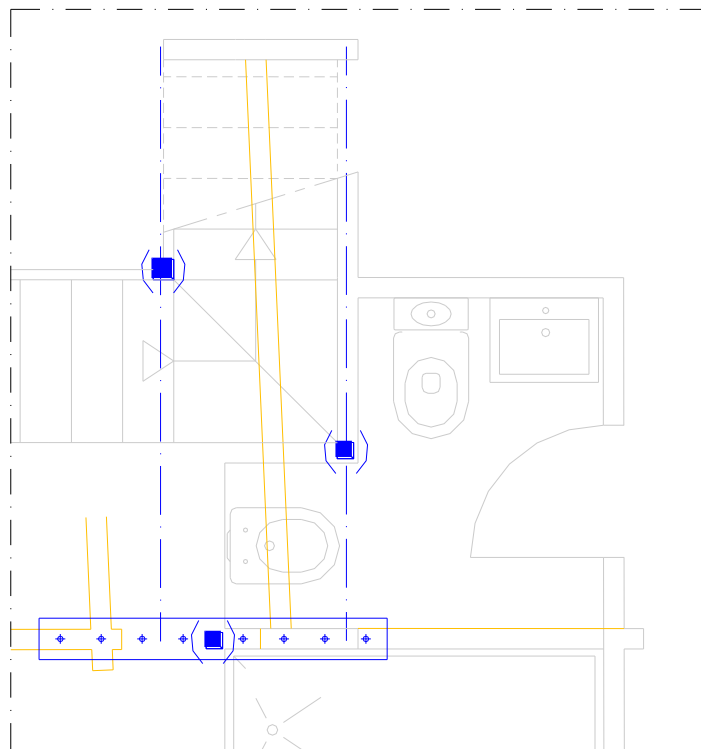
Ligação das vigas de fundação dos pilares à parede resistente (planta)
